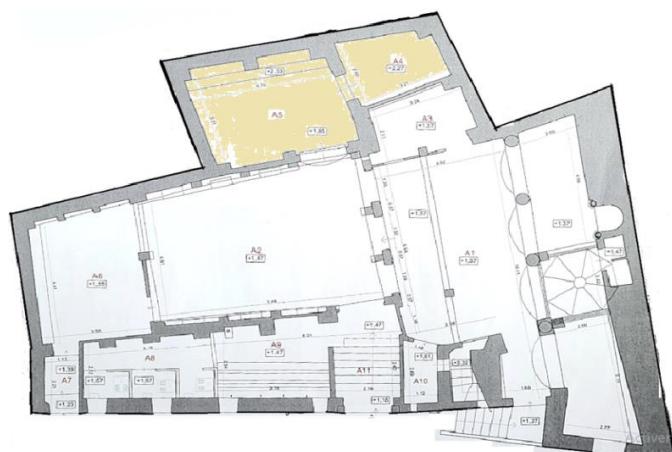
La salle de l'imam. Source : Fond de plan Rocca, traitement auteure
